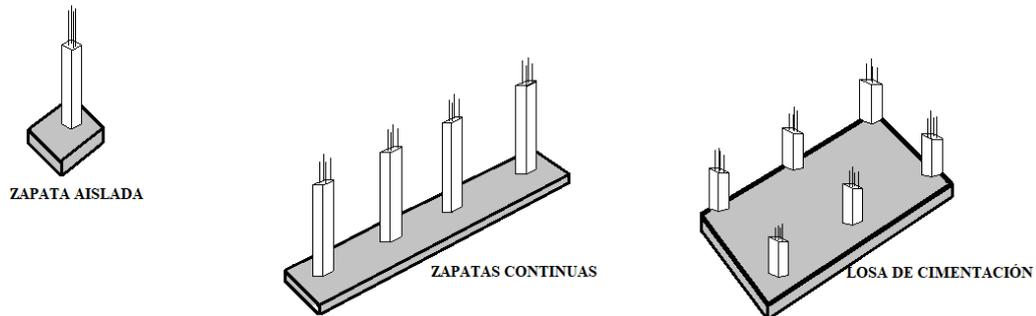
Cimentación para pila. Fuente: (Ingeniería y Construcción, 2013).
